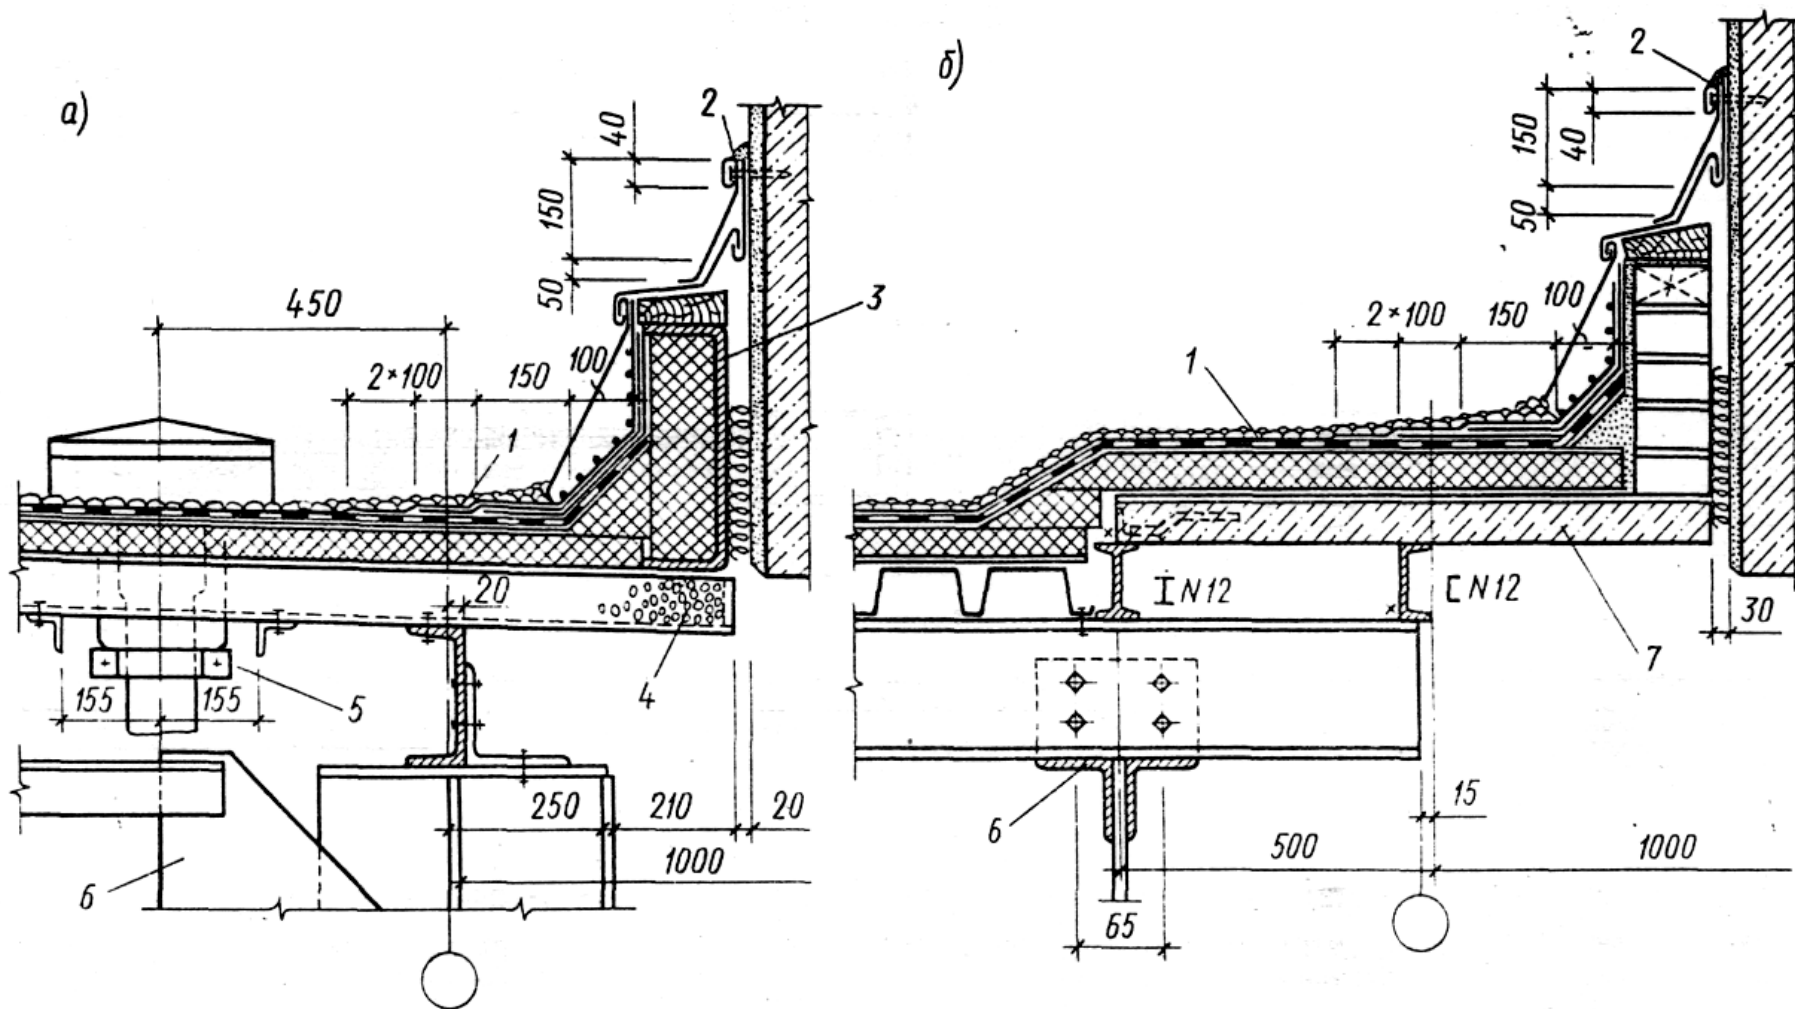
Примыкание легкого покрытия к стене при перепаде высот:
